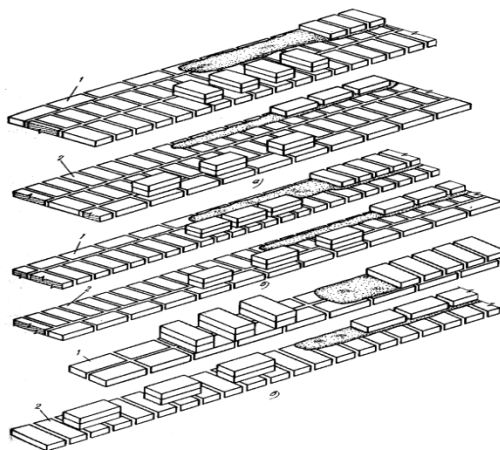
Раскладка кирпича при кладке стен толщиной:
